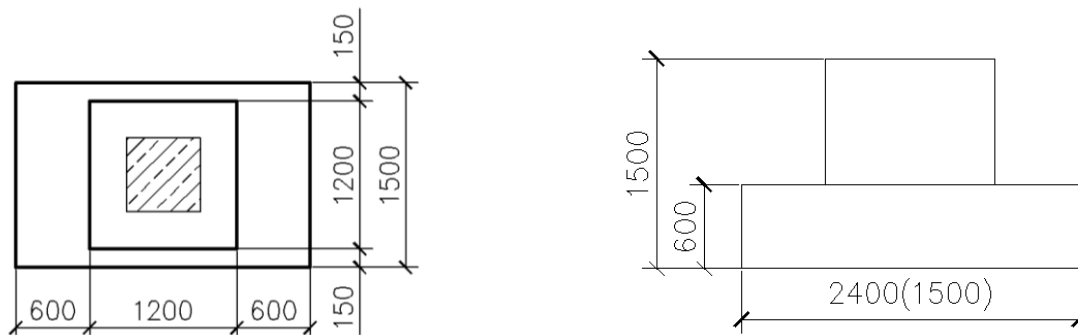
Размеры подошвы и подколонника фундамента
